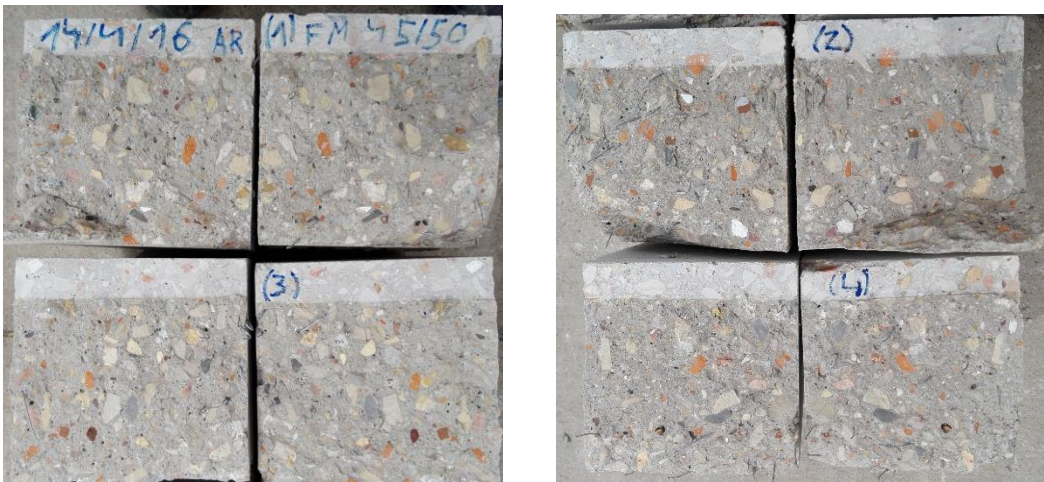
Sección de probetas de hormigón con AR-FM-45/50
